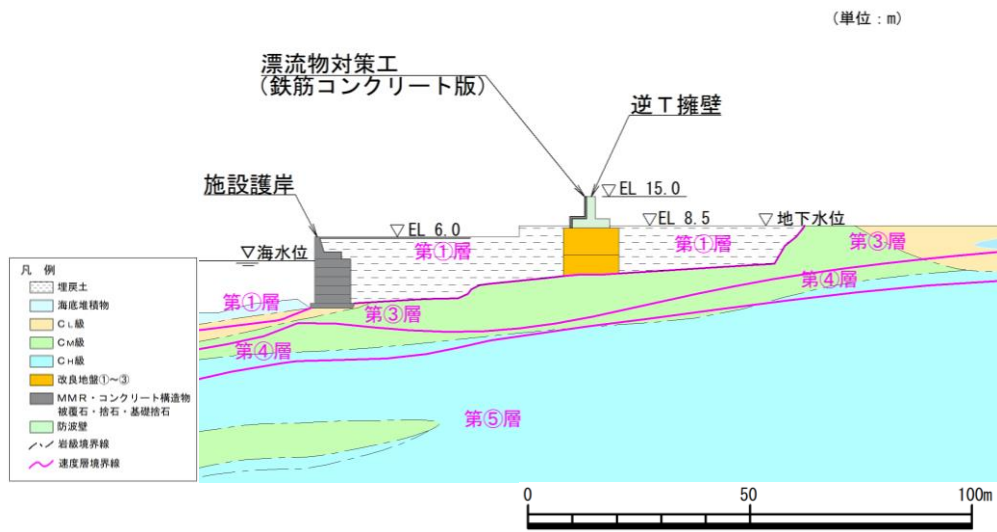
防波壁（逆 T 擁壁）の横断面図（⑥-⑥断面）
